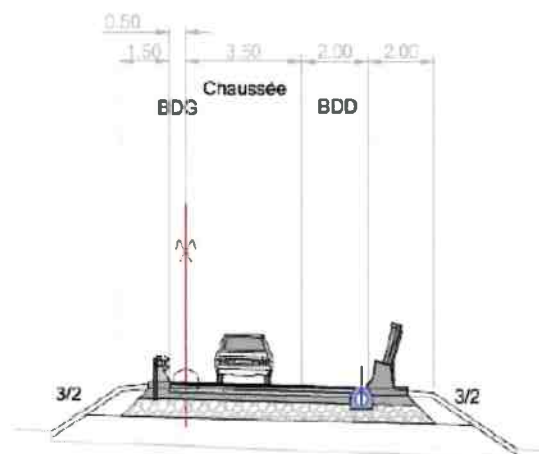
profil en travers type d'une bretelle bidirectionnelle
